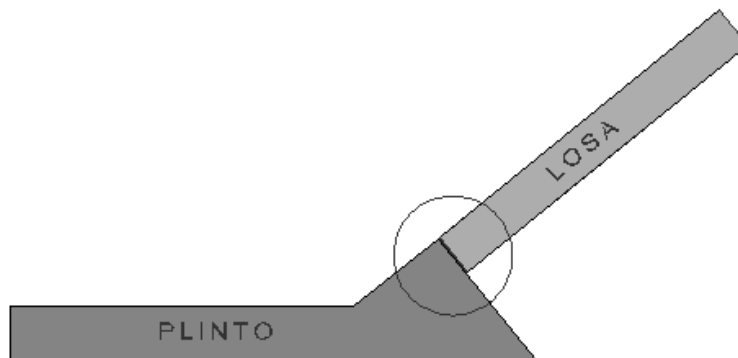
Colocación de material de relleno entre ambas losas expuestas a compresión.
